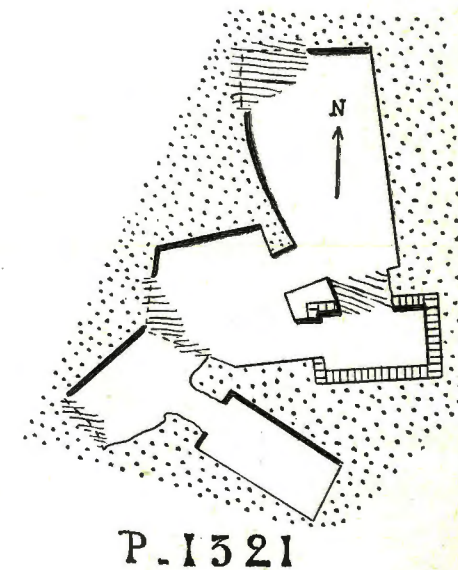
PLAN DE LA TOMBE N° 1321.
